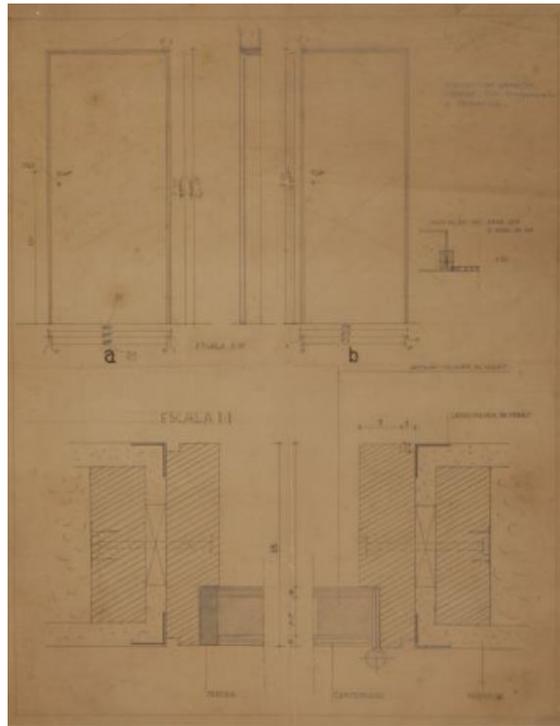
detalle del diseño de puertas para la Casa de Vidrio, 1951, archivo Instituto Bardi
